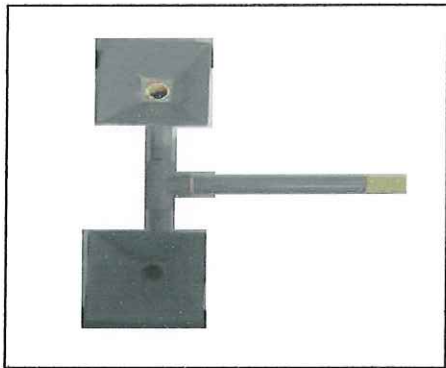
Sistema de trampas y tuberías listo para instalarse.
